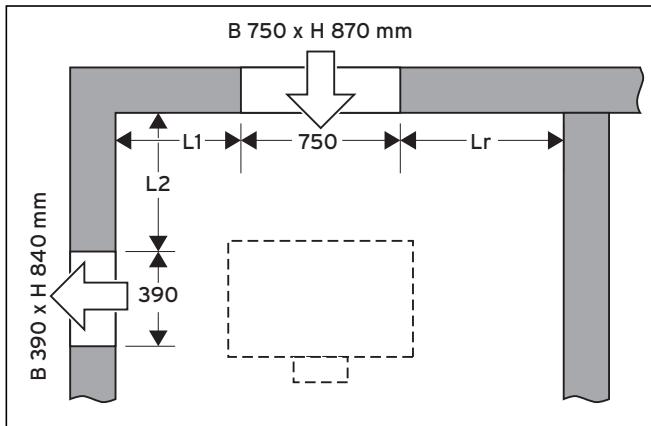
Hjørneinstallation, luftudgang i venstre side
